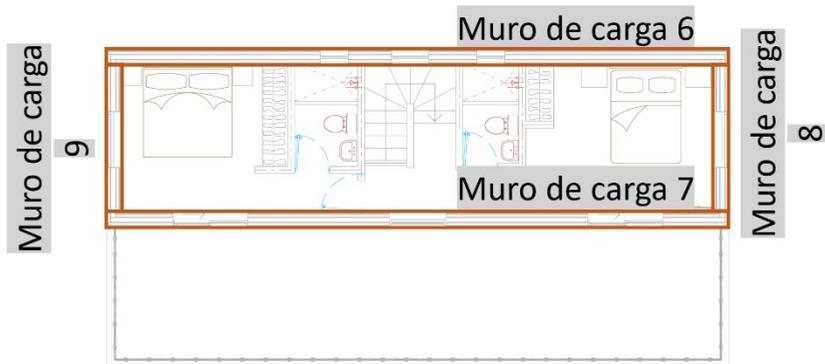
Ubicación muros de carga P1. Elaboración propia
